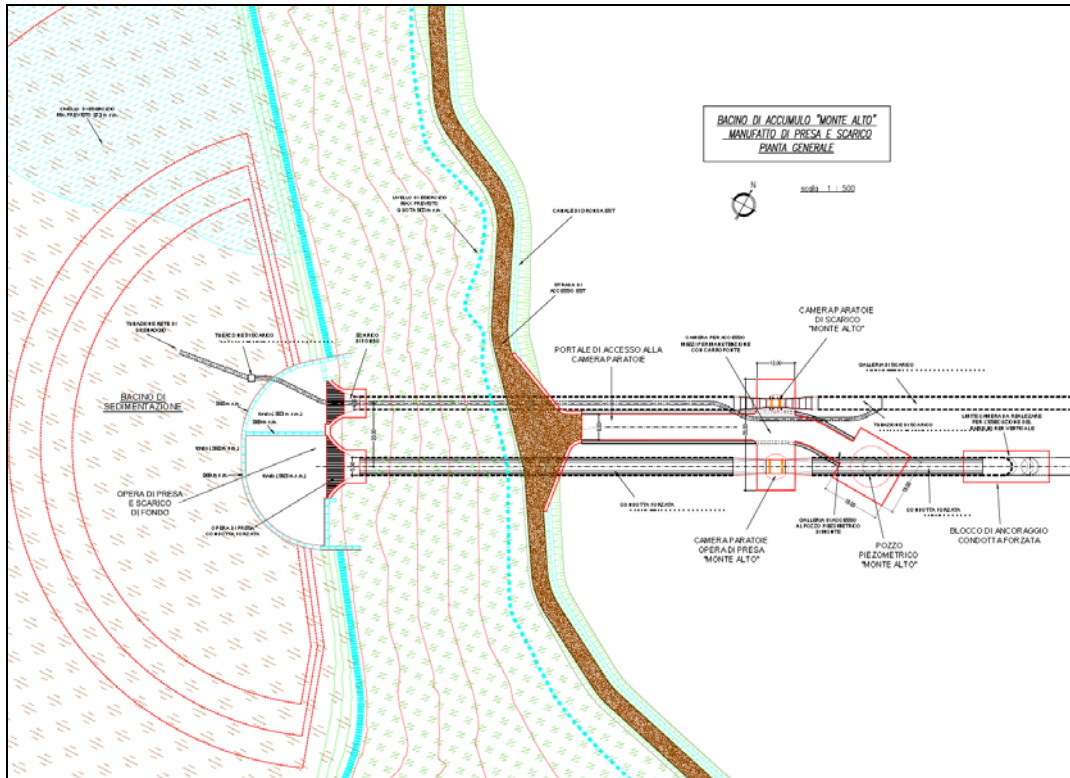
stralcio planimetrico bacino ed opera di presa di Monte Alto
